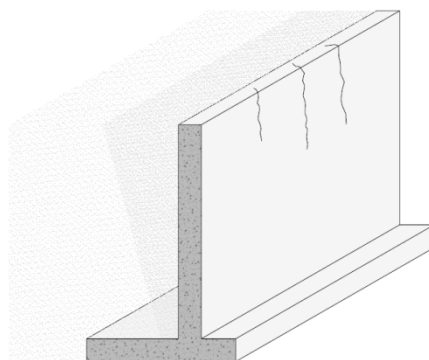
Secció tipus d'un mur amb fissures de retracció hidràulica.
